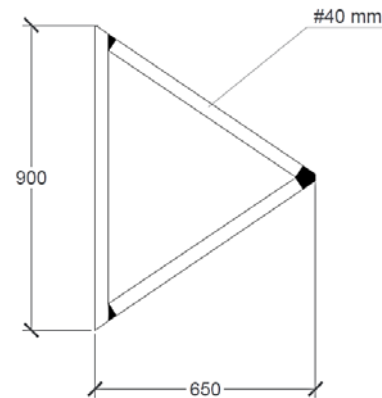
Sección transversal del arco. Elaboración propia con AutoCAD.
